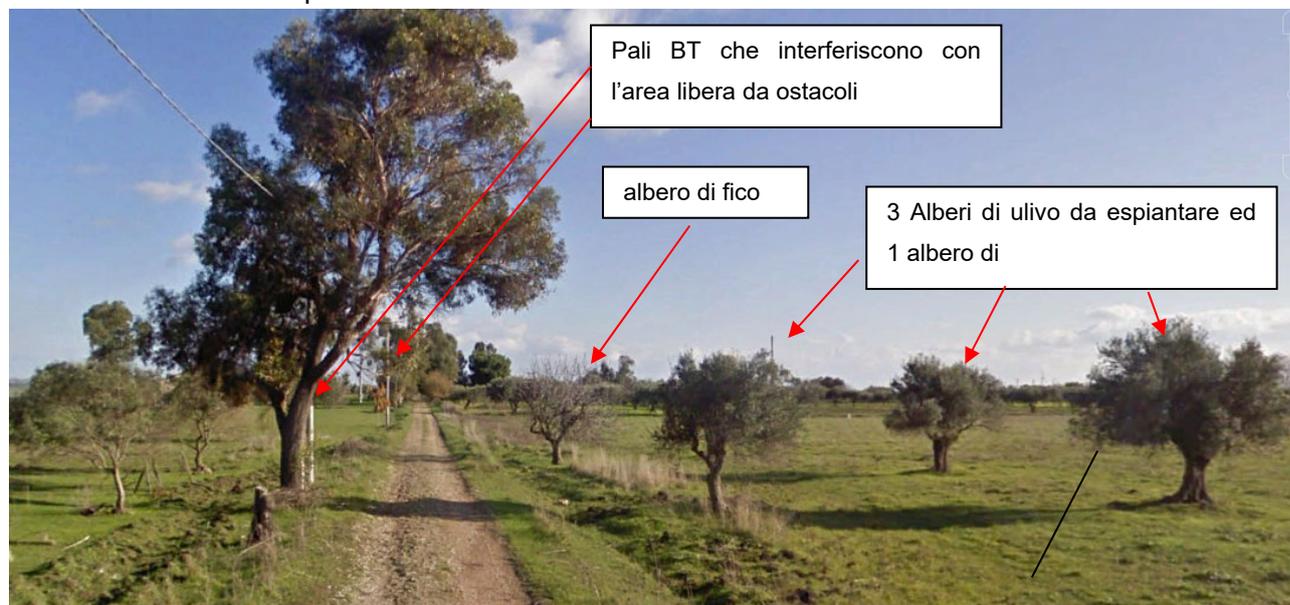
Foto n.1 di figura n.68 Area di manovra definitiva e interferenza con elettrodotto BT e con 3 piante di ulivo.
